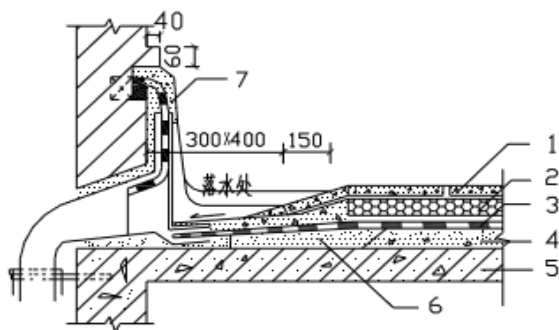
女儿墙处雨水口与屋面关系构造图
